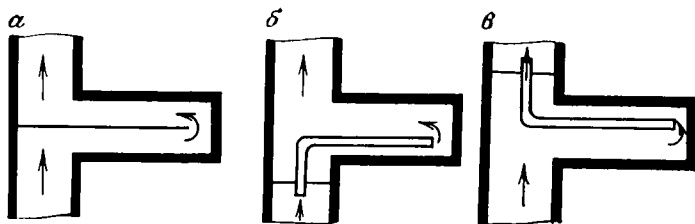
Схемы проветривания тупиковых выработок за счет общешахтной депрессии с применением продольной перегородки (а) и вентиляционной трубы, подающей воздух в забой (б) и отсасывающей воздух из забоя (в)
